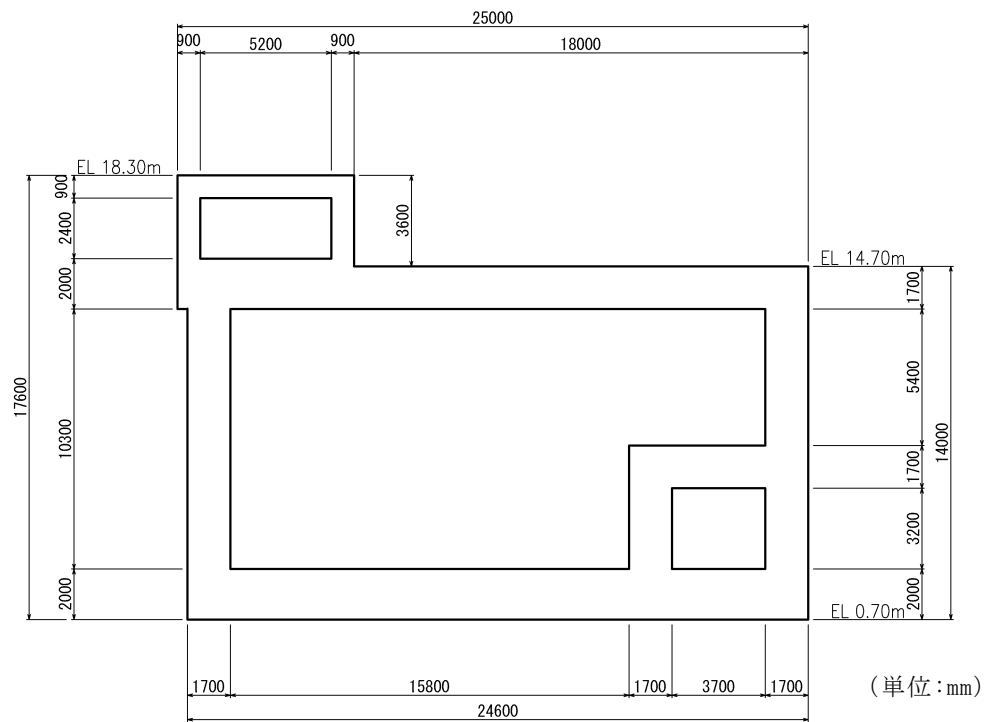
第 1 ベントフィルタ格納槽 断面図 (C-C 断面)
